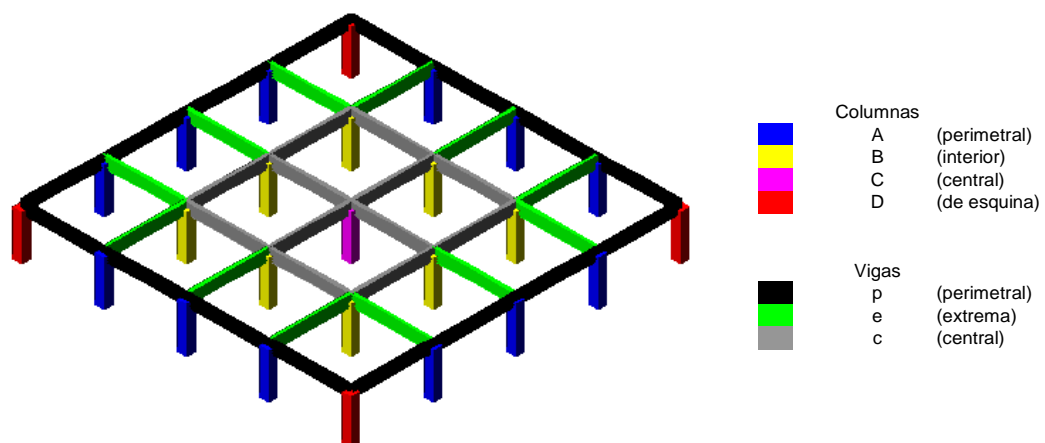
Clasificación de columnas y vigas con fines de diseño
